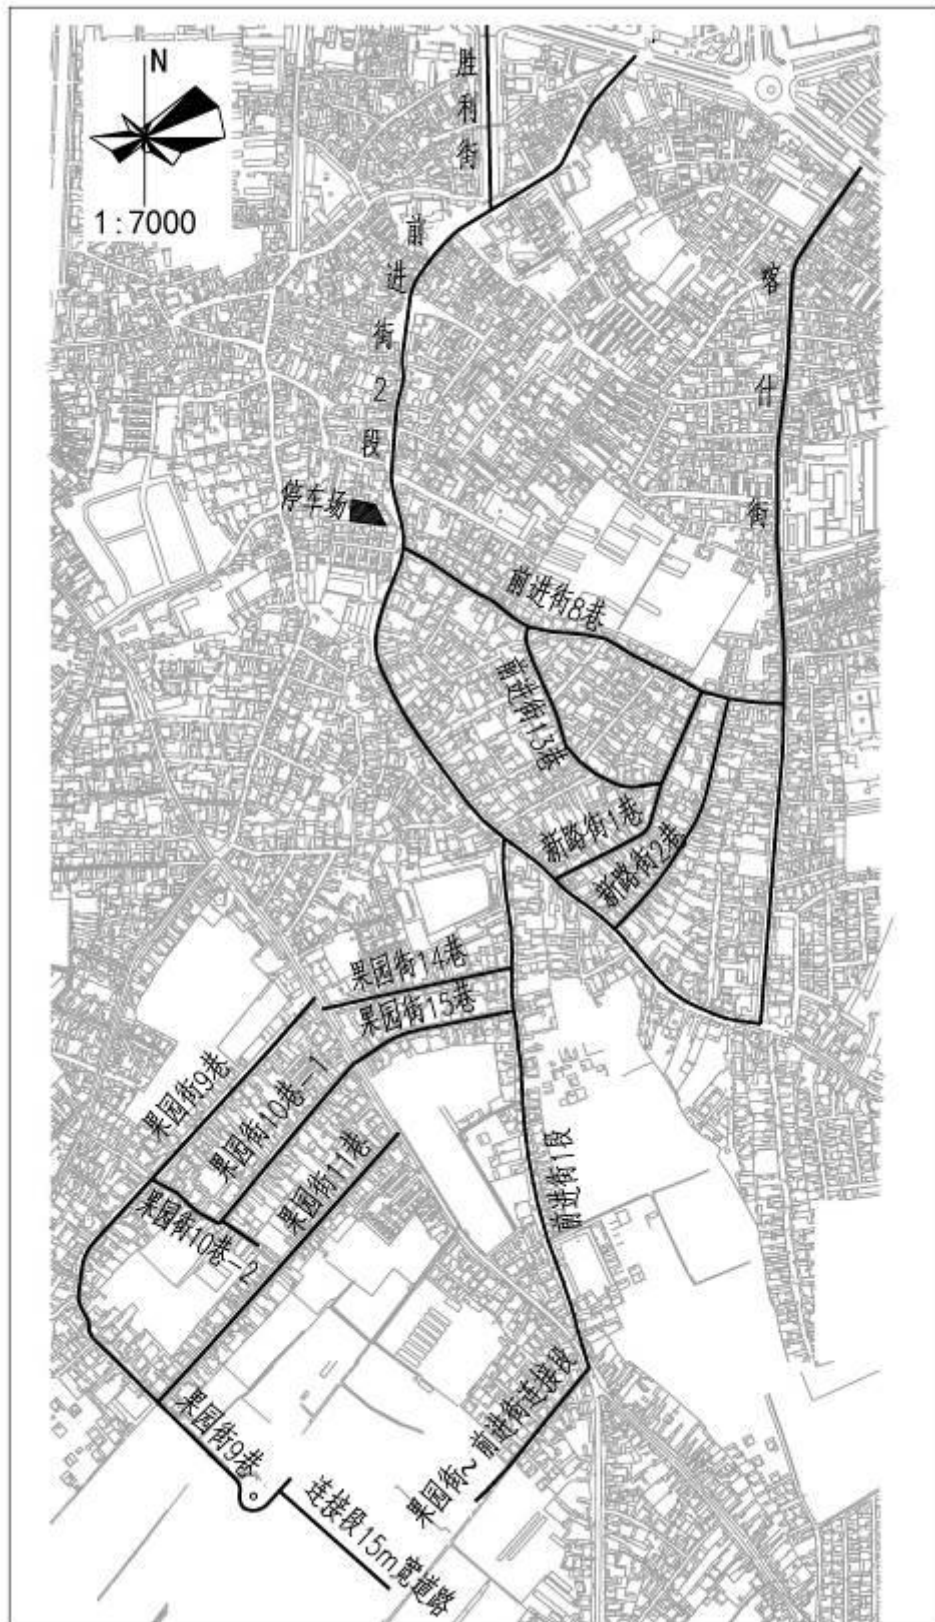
(c) 喀赞其片区巷道改造总平面图
